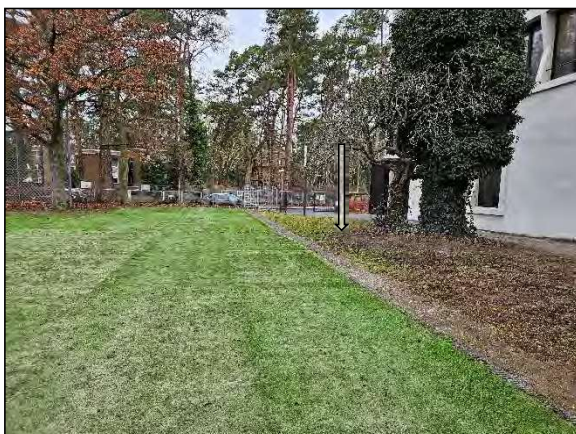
Aufschlusspunkt HB 03/25, Blickrichtung Westen/Nordwesten
